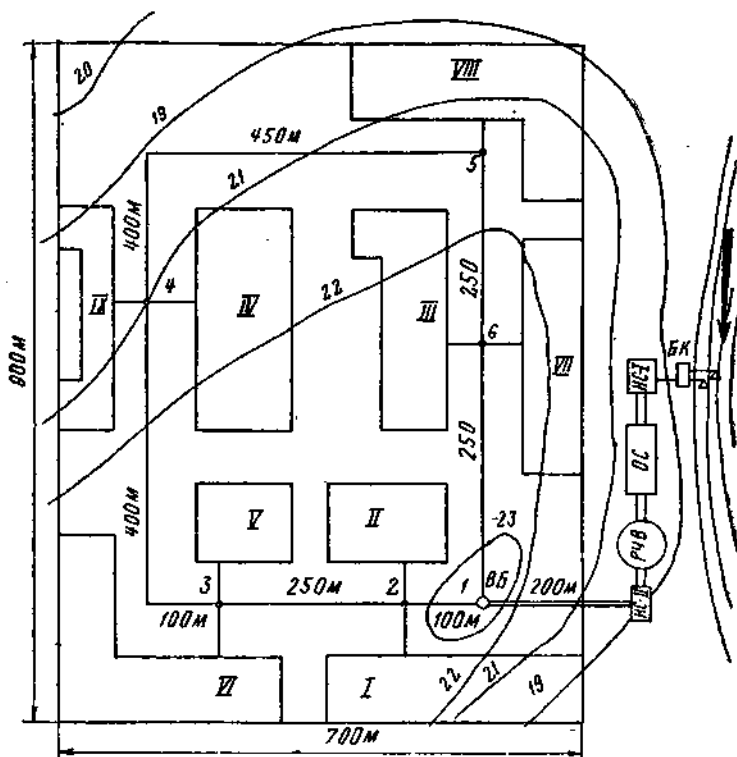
Генеральный план текстильной фабрики с водопроводной сетью
